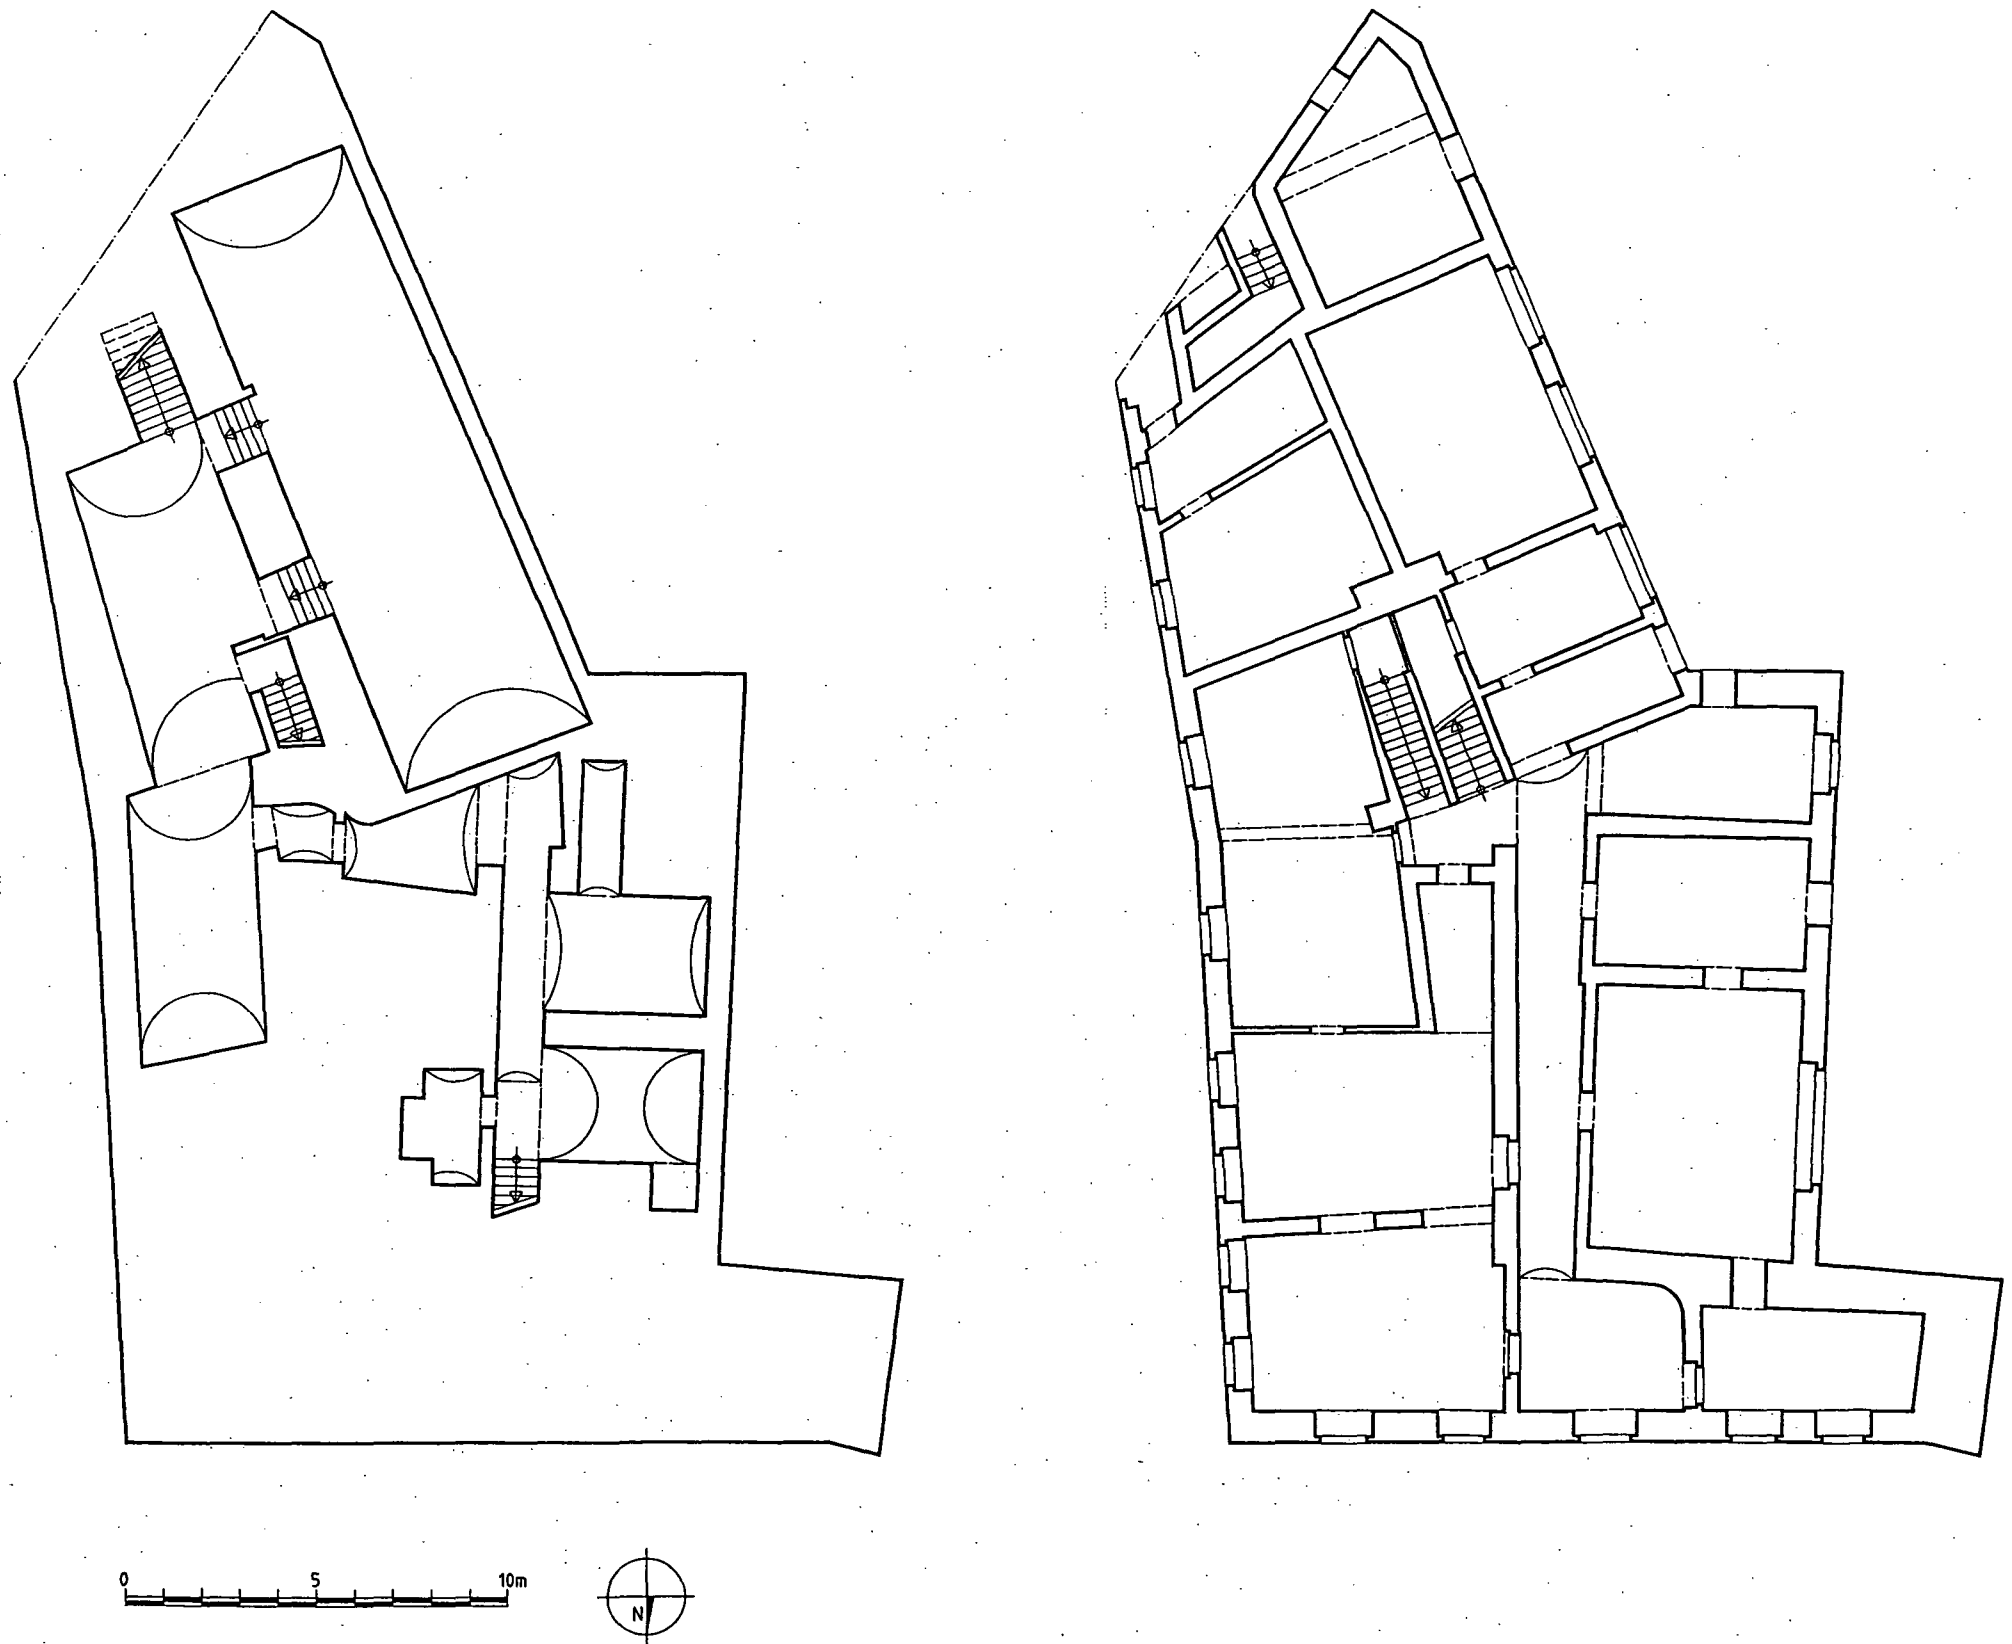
Schmiedstraße 29 – Grundrisse Keller, Erdgeschoss (1:200).
